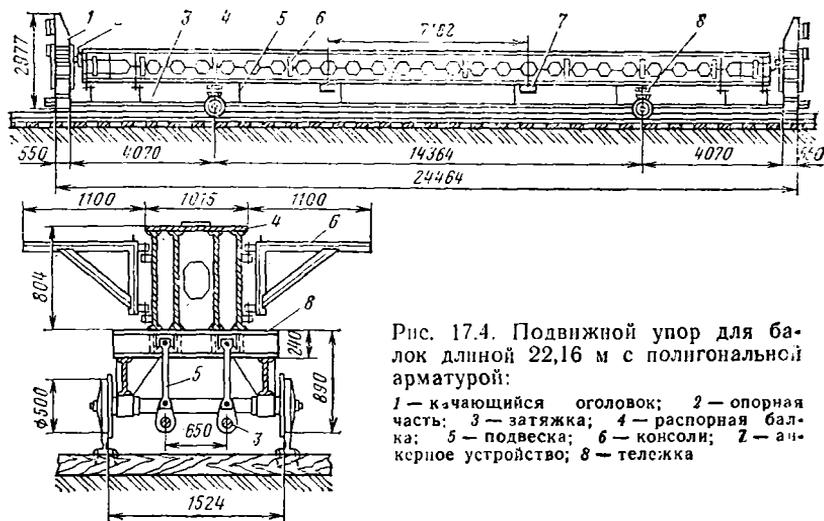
Подвижной упор для балок длиной 22,16 м с полигональной арматурой:
